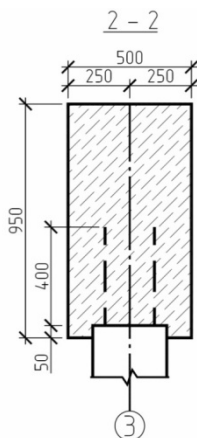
Поперечный разрез ростверка 2-2
